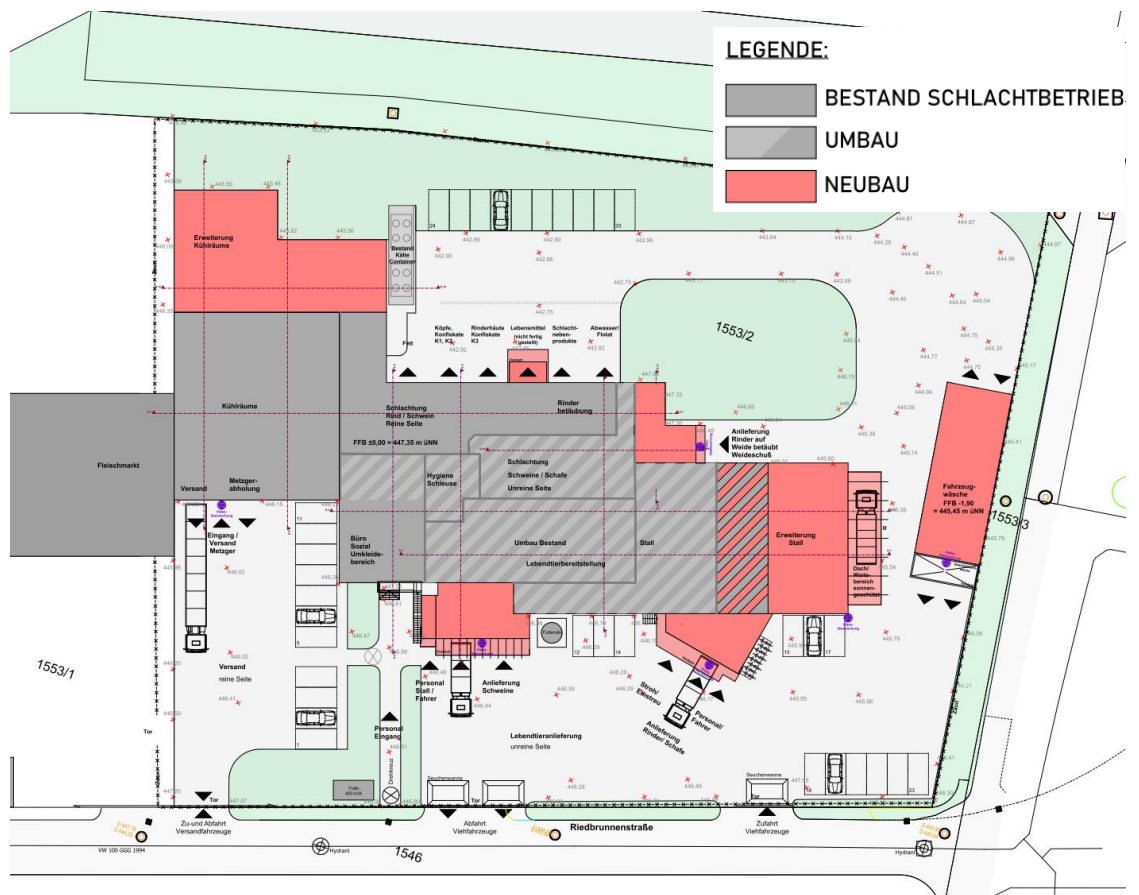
Neuausrichtung Wiederinbetriebnahme Schlachthof Gärtringen, Lageplan, Falkenstein Architekten und Ingenieure GmbH, Aulendorf, 12.04.2023
